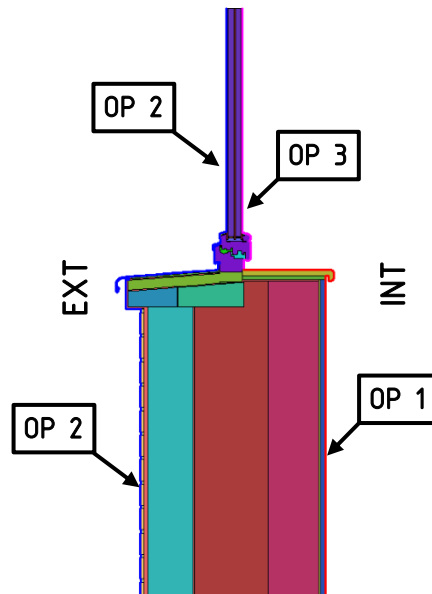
NÁVRH, VNĚJŠÍ ZATEPLENÍ – Parapet okna
